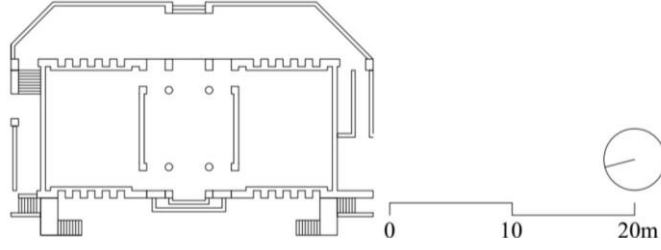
IIM Kompleksi, seçilmiş binaların kat planlarını gösteren anahtar planı
